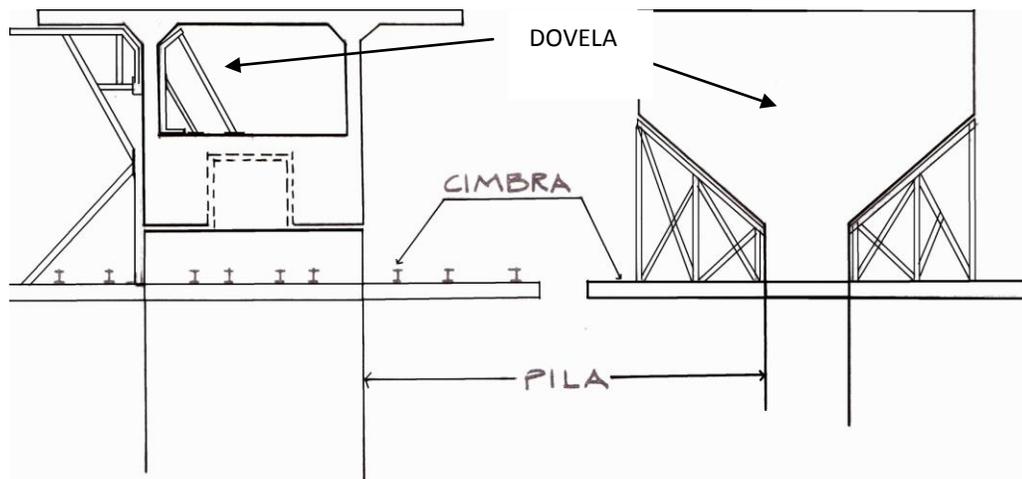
Obra falsa donde se apoya la dovela colada sobre la pila
